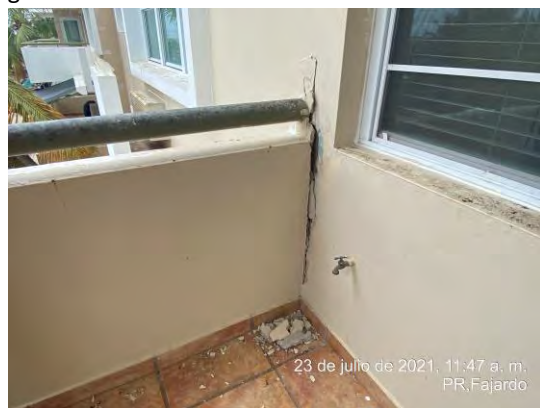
Se hayó una grieta profunda en un balcón poco común en el balcón del tercer nivel, lado derecho del lado oeste del edificio 3 (C).
